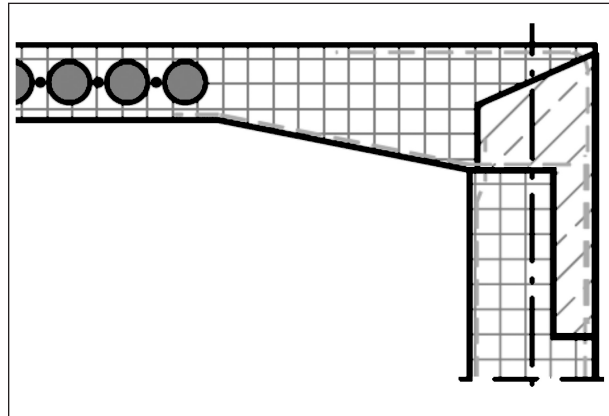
Ortbetonverguss von hinten, rückseitige Schalung mit Vergussöffnung
